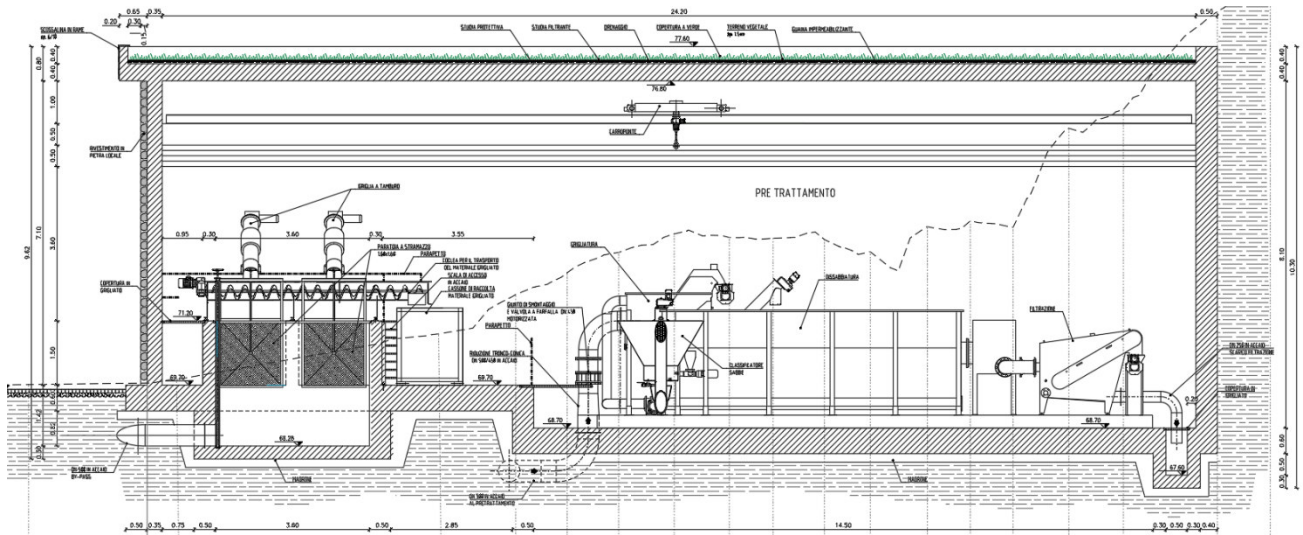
Sezione interna dell'impianto di Brancolino – grigliatura fine delle 5Qm (a sinistra) – pretrattamento delle acque di sfioro (a destra).
